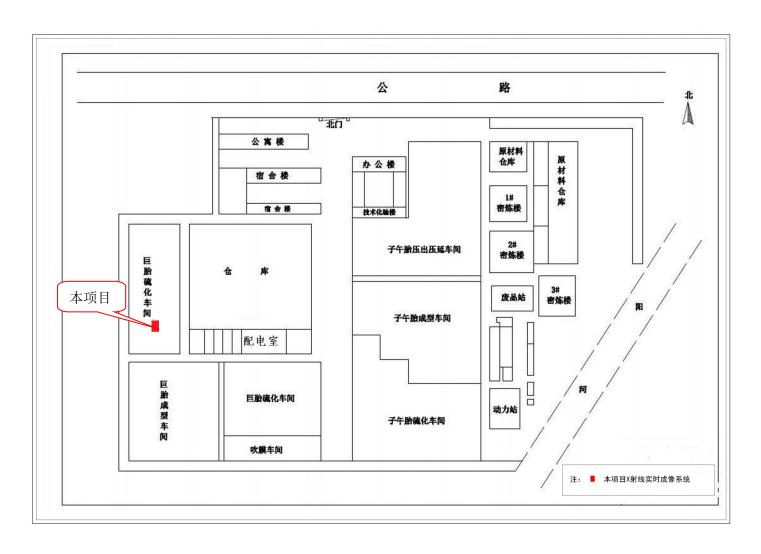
山东银宝轮胎集团有限公司总平面布置示意图
